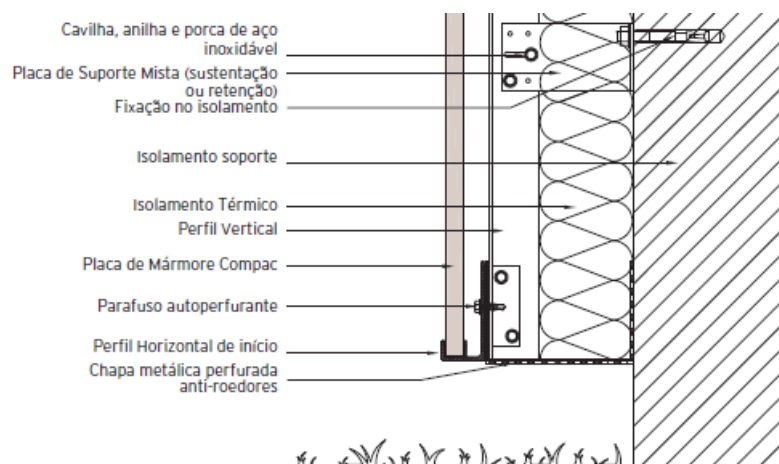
Detalhe construtivo de remate inferior – Base [79].
